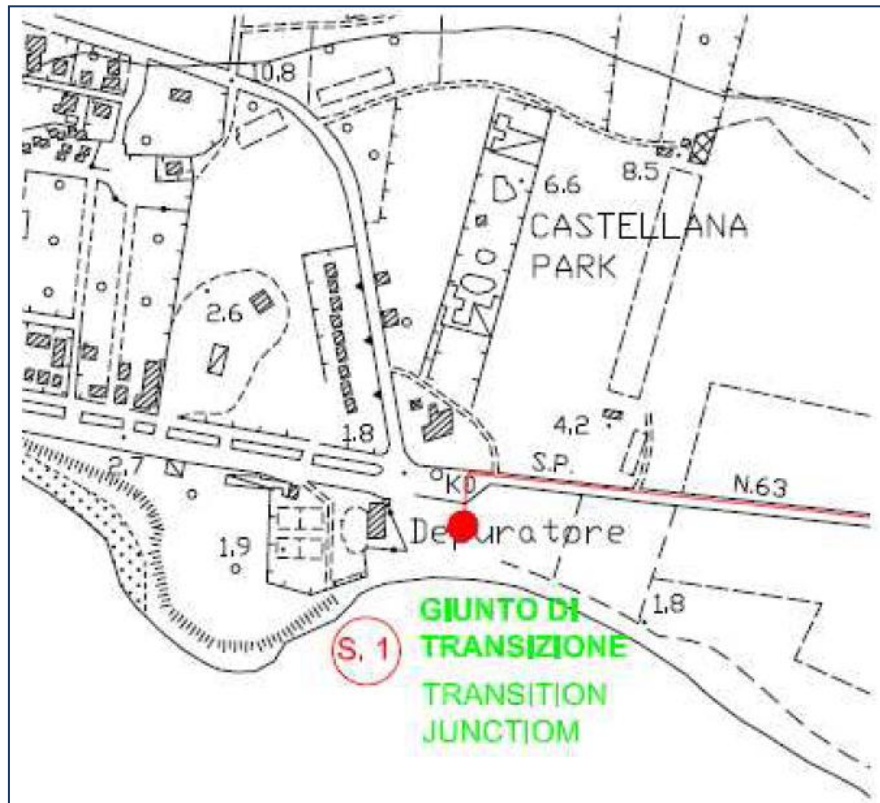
Planimetria del tracciato con il posizionamento degli scavi di indagine
